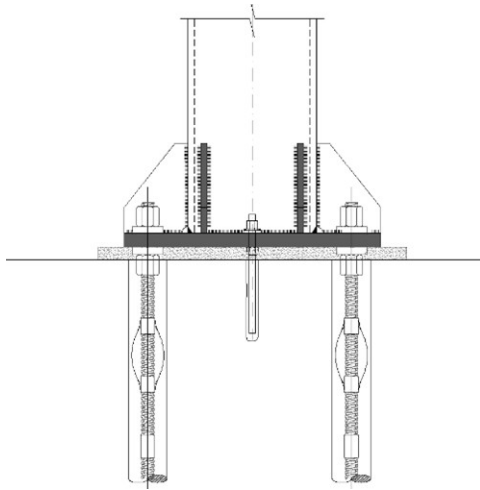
Cimentación apoyos traccionados de muletas fondo sur.
